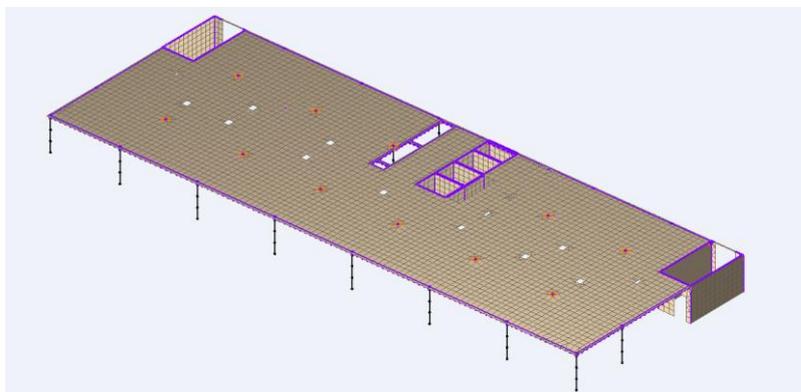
Модель плиты перекрытия на отметке плюс 19.200
